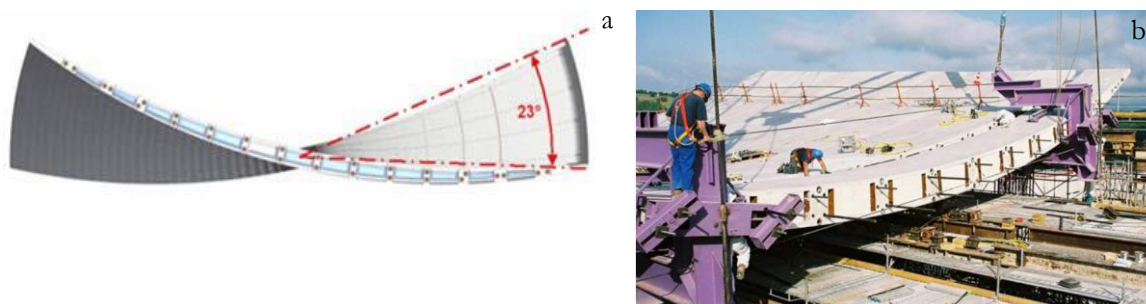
a) Rotação da secção transversal; b) Cobertura em construção
